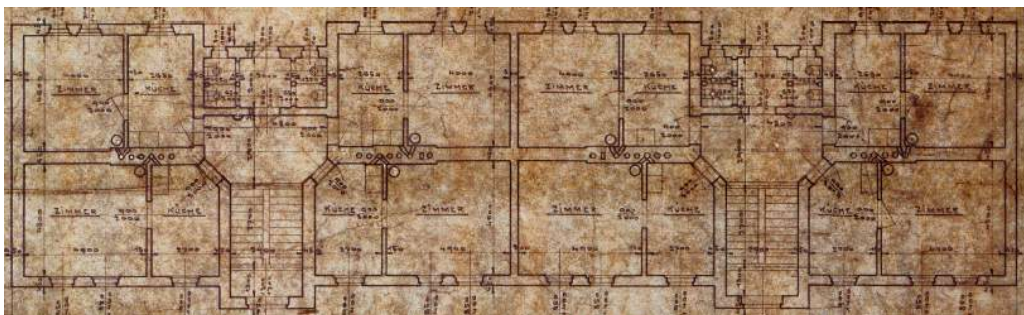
Grundriss Wohnanlage Vordernbergstraße 50-56, Eisenerz
